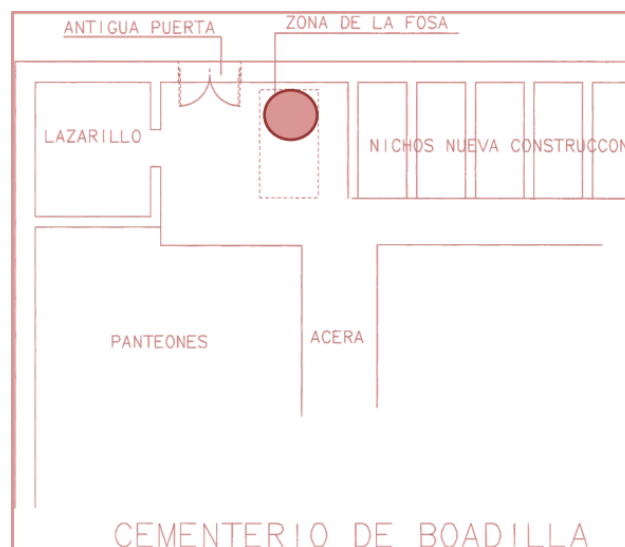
Plano del cementerio de Boadilla. El círculo rojo indica donde estaba situada la fosa (Castro Lois *et al.*, 2018)
